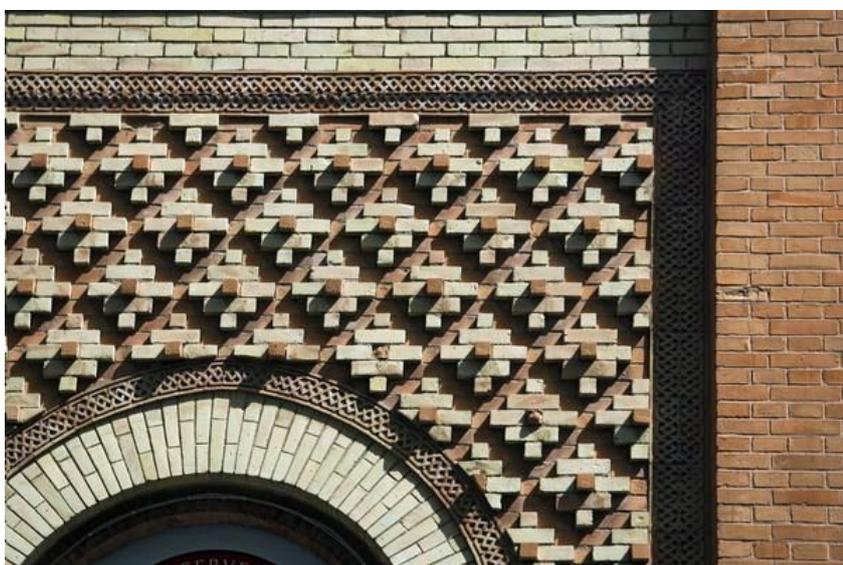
Detalle fachada ladrillo. Estación de Sevilla Plaza de Armas. IAPH.
